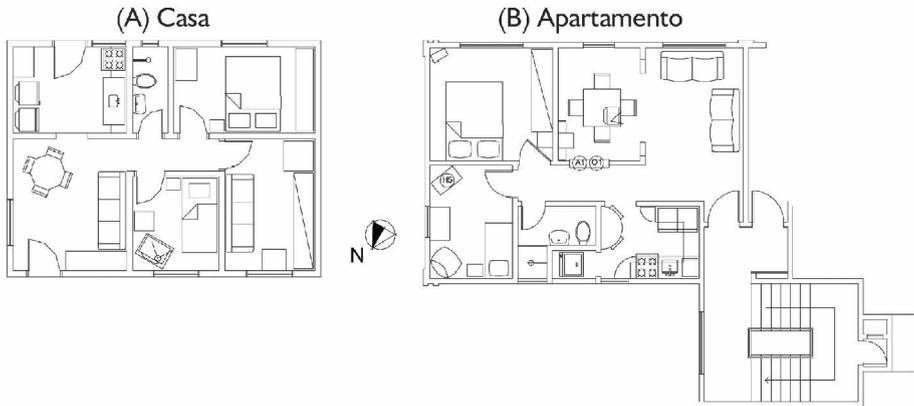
Planta baixa das tipologias originais do conjunto habitacional : A =casa, B= apartamento.
